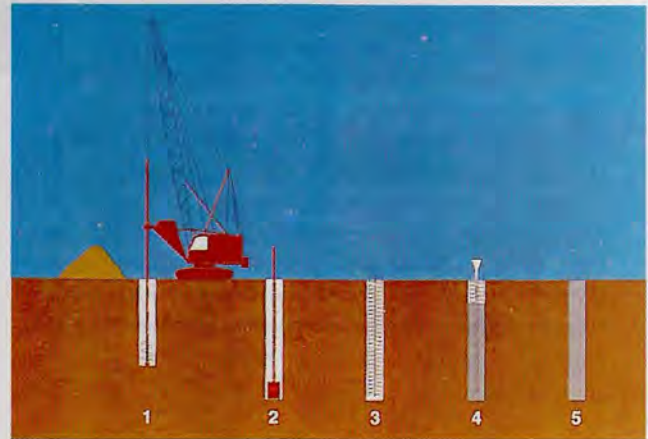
Proceso constructivo de pilotes hormigonados *in situ* a rotación en seco. 1) Perforación con hélice o cazo en orificio estable. 2) Limpieza del fondo con cazo, si procede. 3) Colocación de la armadura. 4) Hormigonado con tubo «tremie». 5) Pilote terminado.
